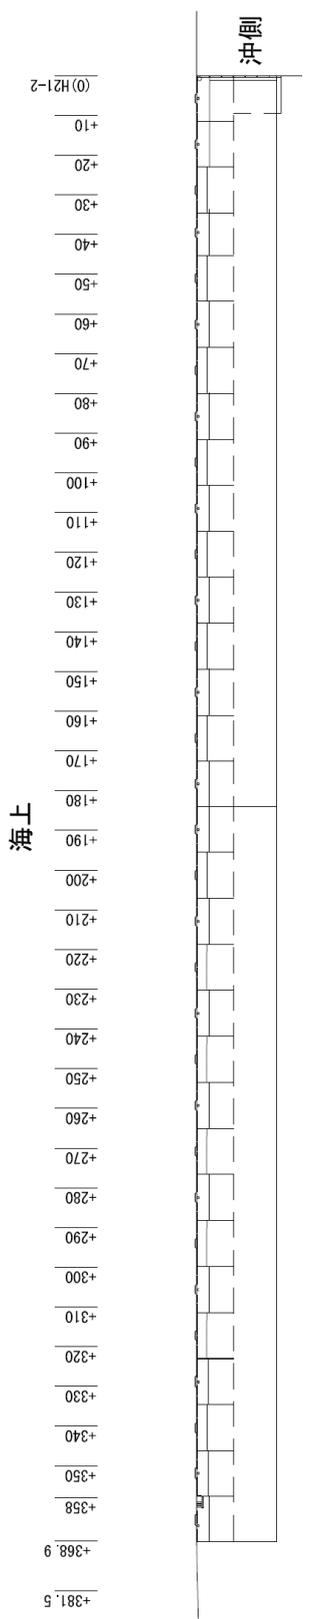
59 No.2 日立港区_第5ふ頭地区岸壁(-10m)C の平面図 (被災前後)
